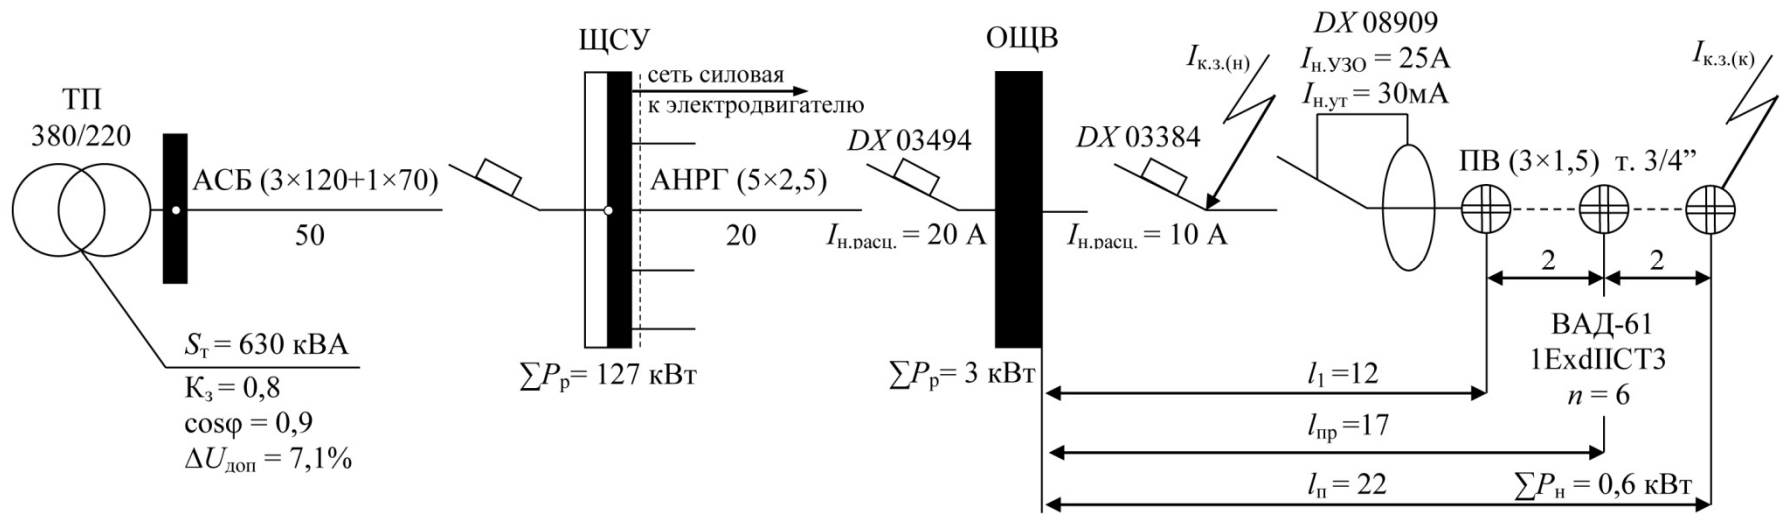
Расчетная схема осветительной сети здания насосной станции
